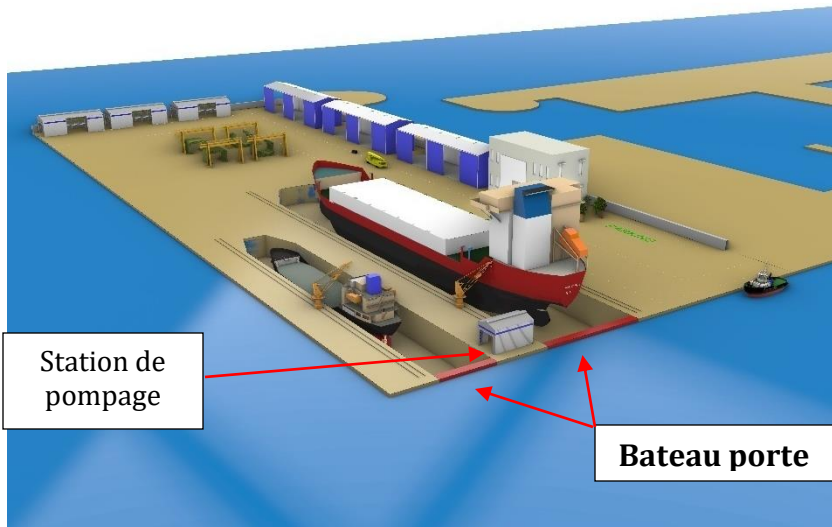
Plan N° 04 : Vue nord-ouest du chantier naval en 3D, avec les deux cales sèches et les différents ateliers.
